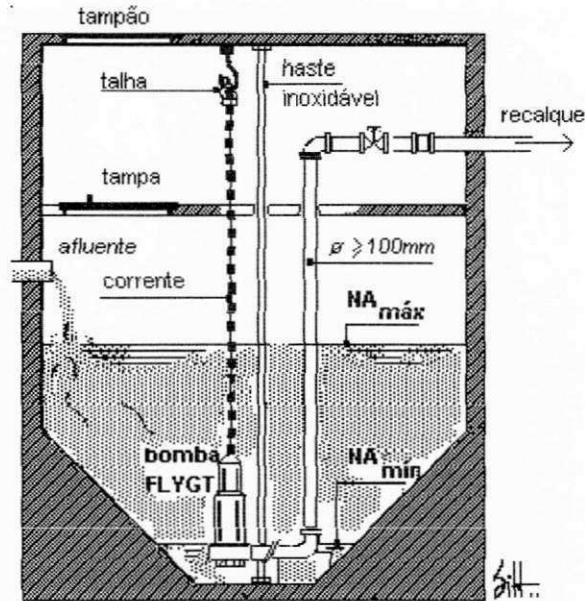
4 - Instalação típica para bombas FLYGT
